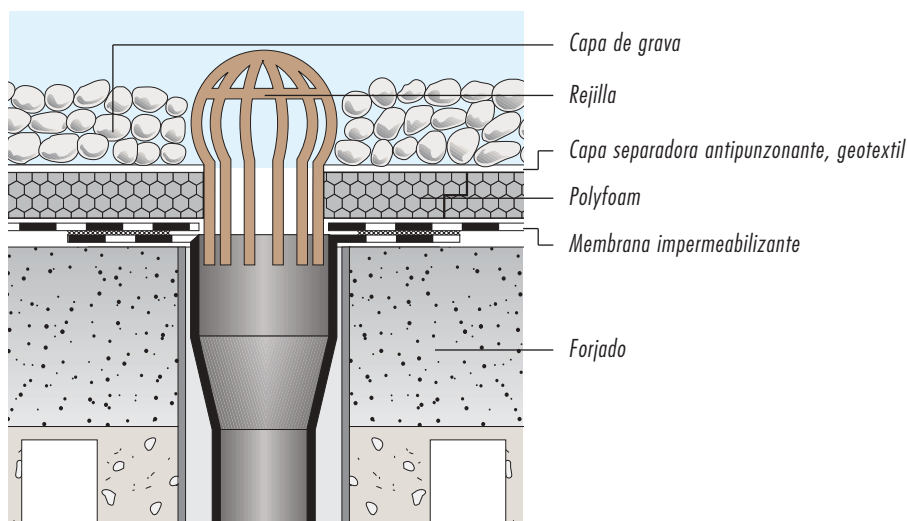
Detalle de sumidero con drenaje a dos niveles: sobre el aislamiento y sobre la membrana impermeabilizante
